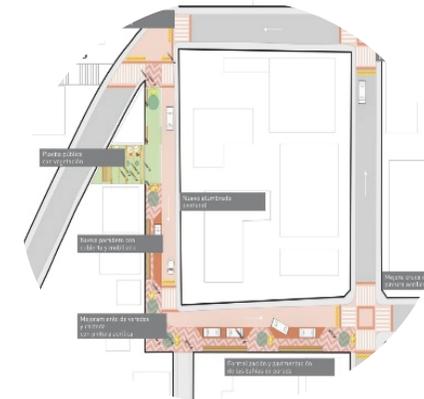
Render de propuesta del plan piloto en puerto Vara, Chile
